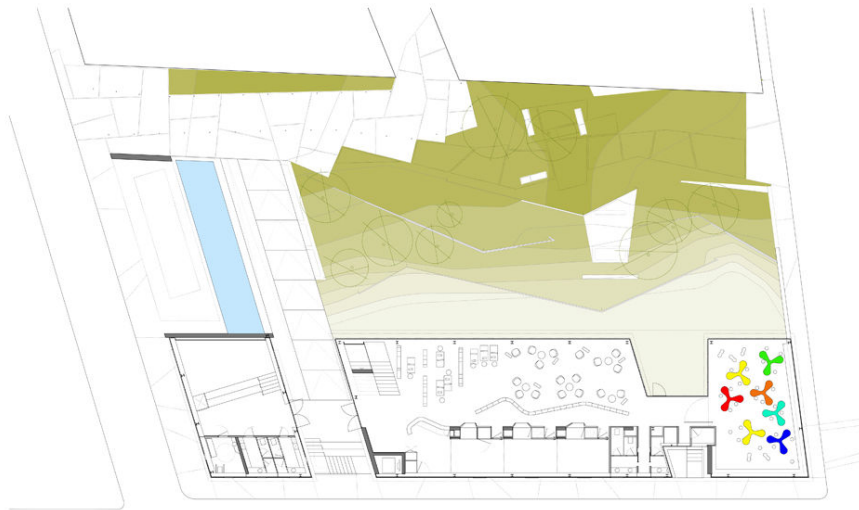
Planta primeiro pavimento (DIEZ, 2009)
